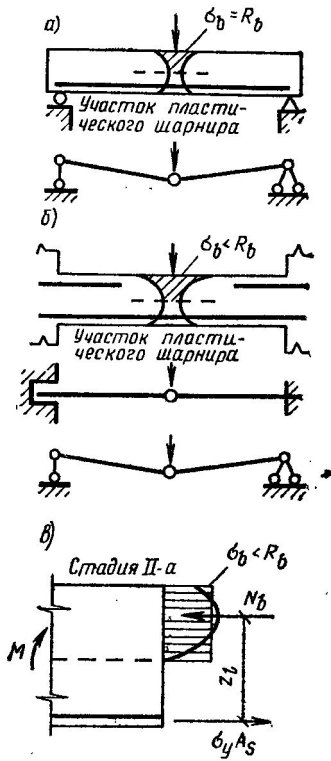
Схема образования пластического шарнира в железобетонных балках
